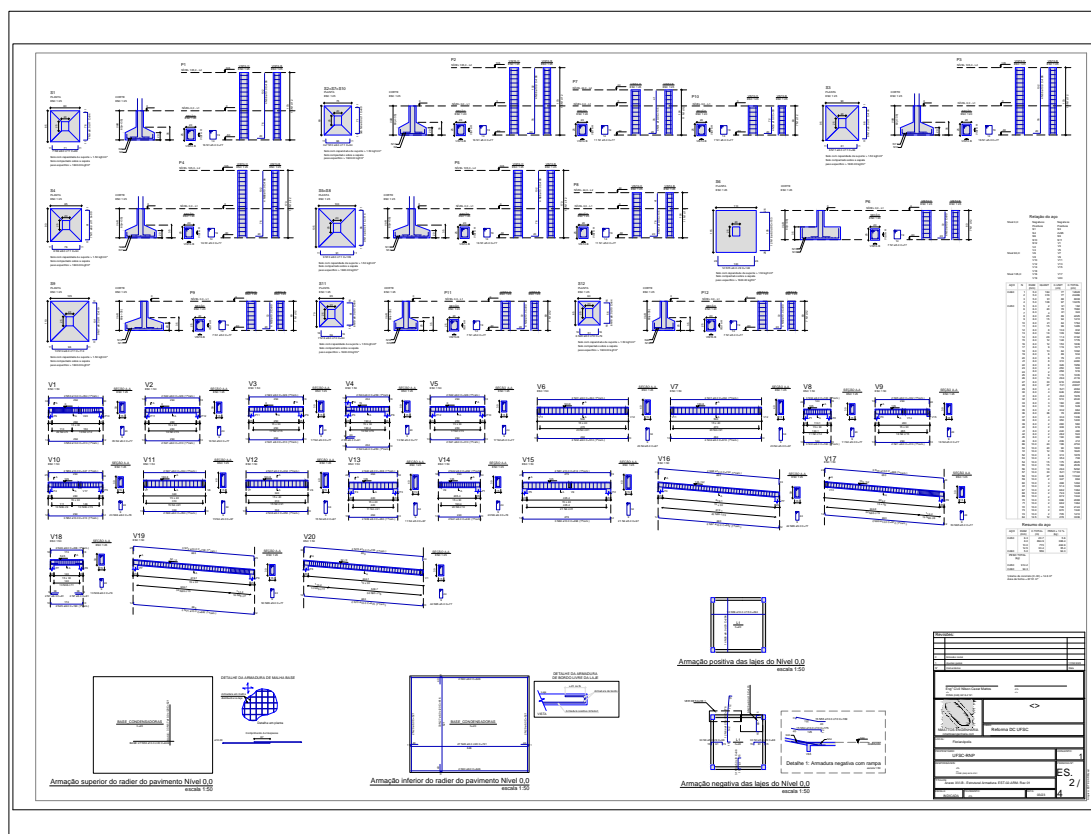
Anexo XVI-B - Estrutural Armadura- EST-02-ARM- Rev 01-Layout1
